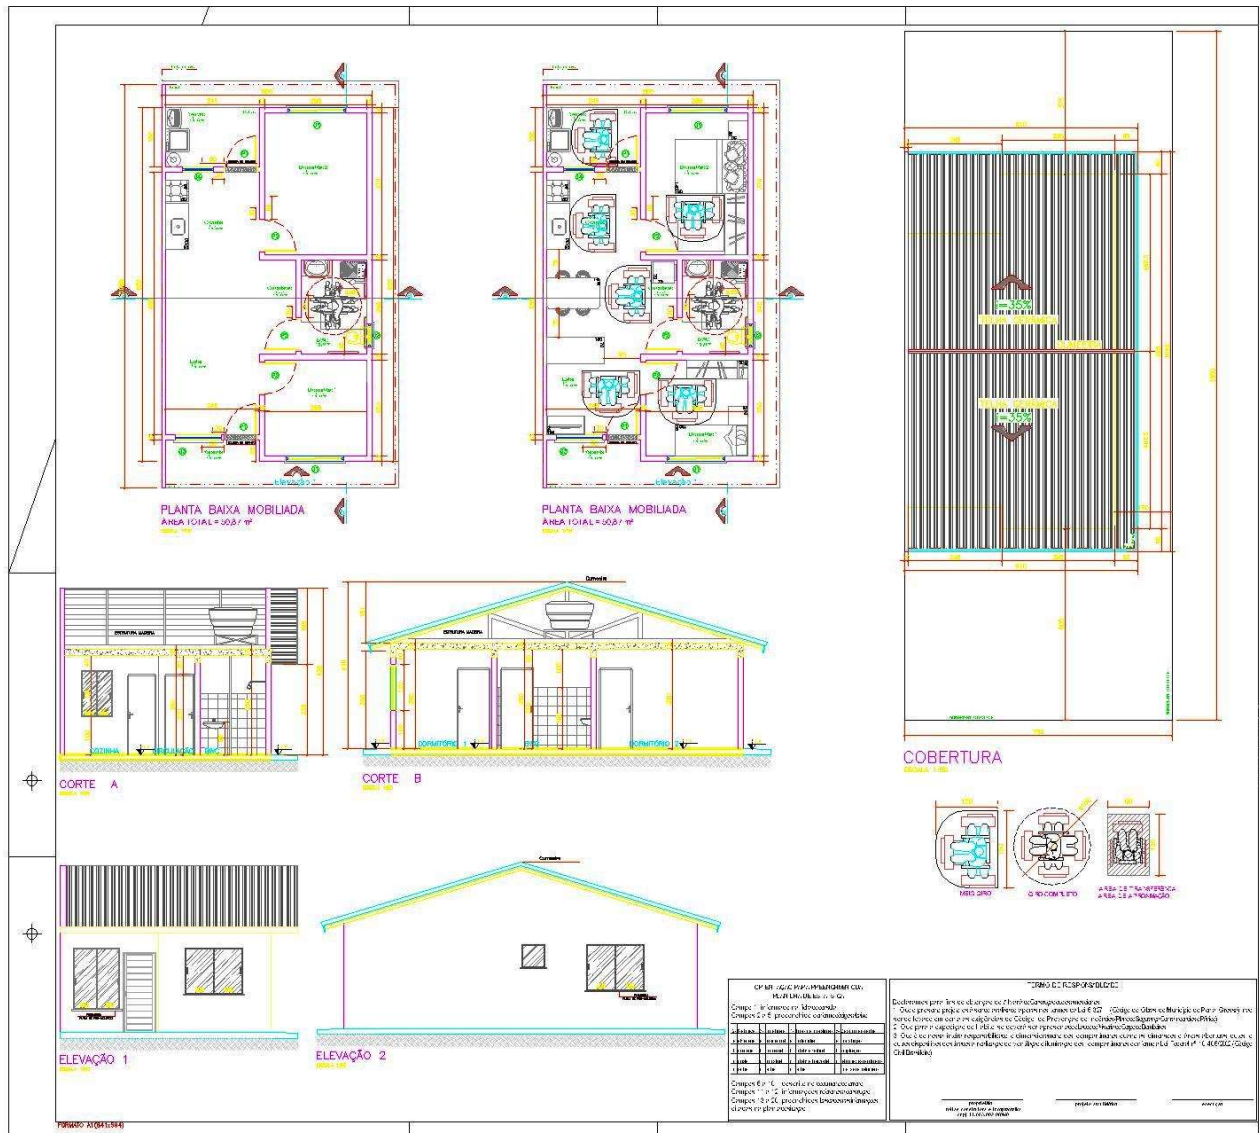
Planta baixa, cortes e vistas - modelo PNE.
